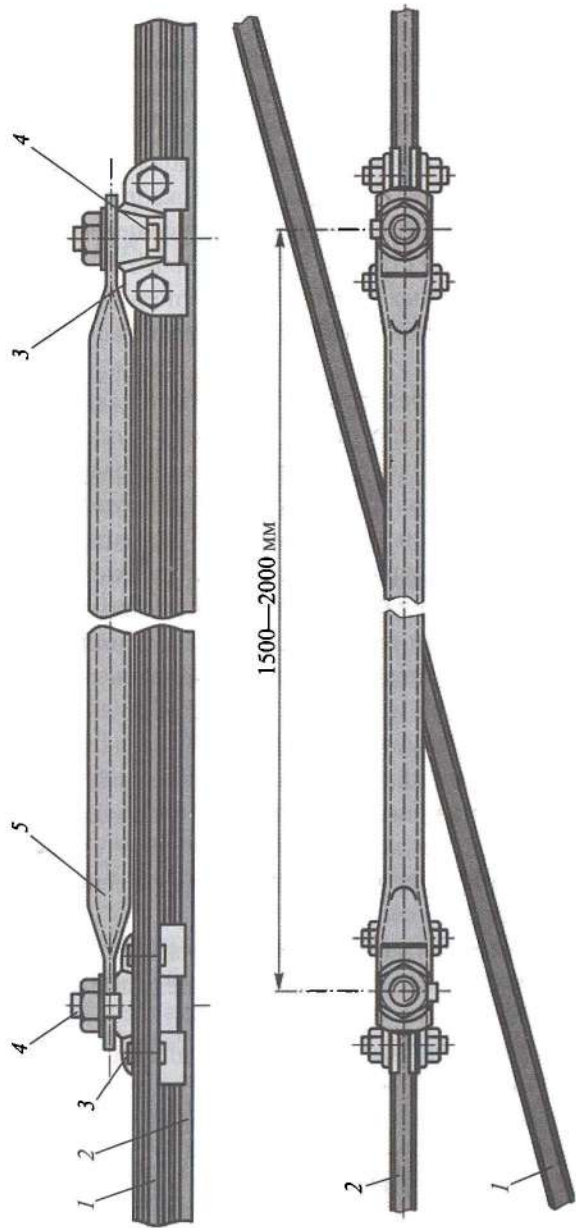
Ограничительная накладка, применяемая при пересечении контактных проводов на воздушной стрелке:
